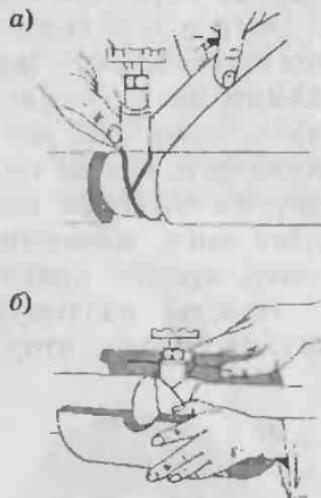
Последовательность монтажа тепловой изоляции запорной арматуры: а — обматывание теплоизоляционной лентой; б — закрытие саркофагом
